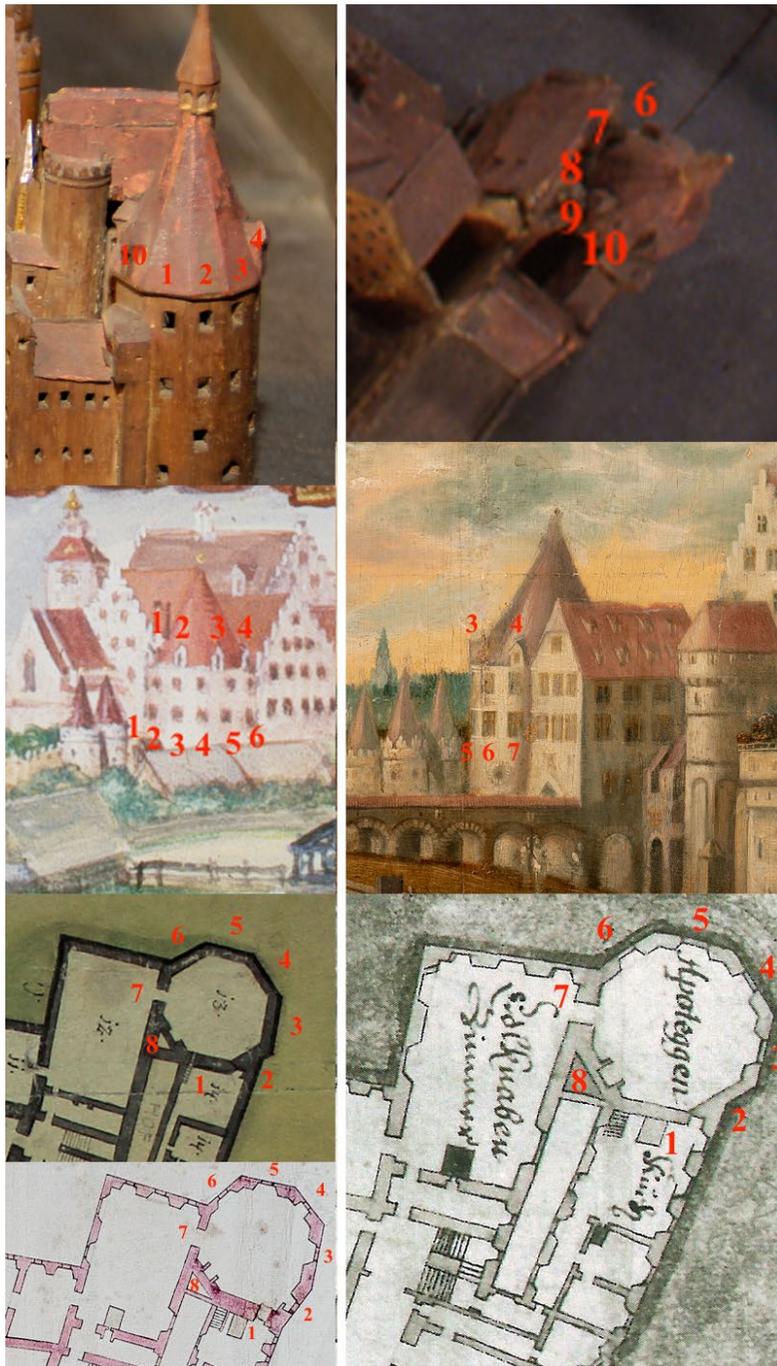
Äußerer Christopherturm, Montage, Sandtner 1570, Mielich 1559 und 1561, Brandplan 1750, Tambachplan 1630, Pariser Plan 1630a, JL
